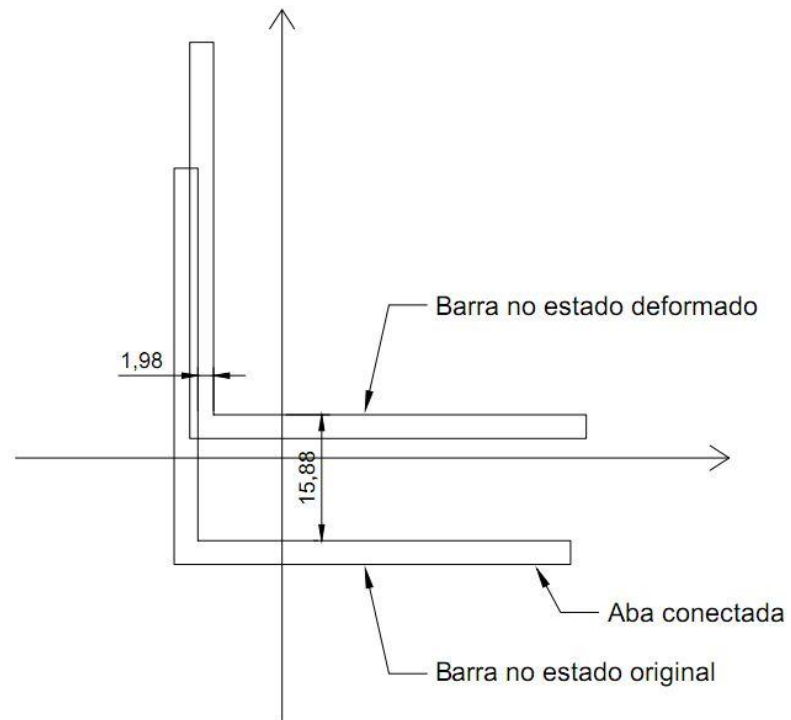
Cantoneira no estado original e estado deformado para esbelteza 90. Fonte: O autor.
